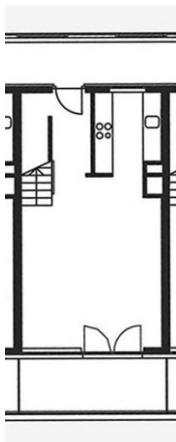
3-Zimmer- Maisonette, Bauteil A Ganahl Iftsits Larch Arch.
